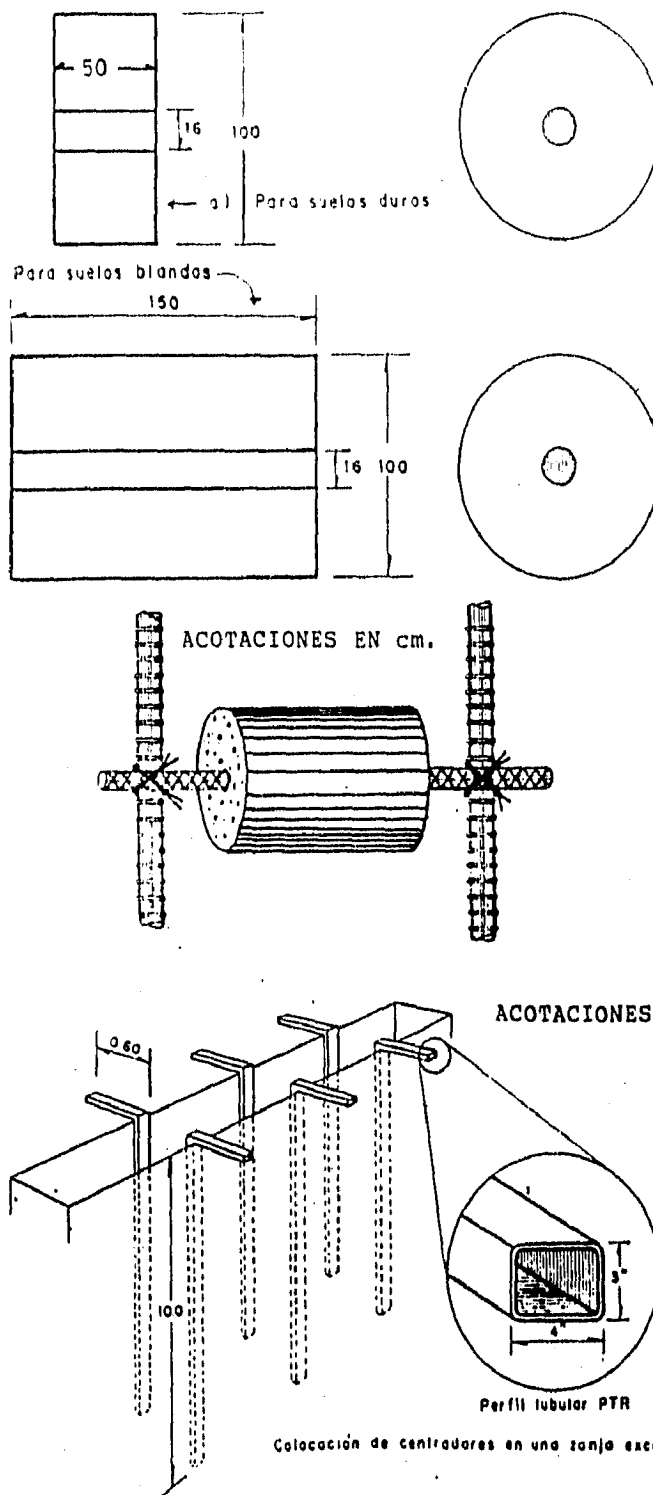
ROLES Y CENTRADORES PARA GARANTIZAR LA CORRECTA COLOCACIÓN Y RECUBRIMIENTO DEL ACERO DE REFUERZO.
